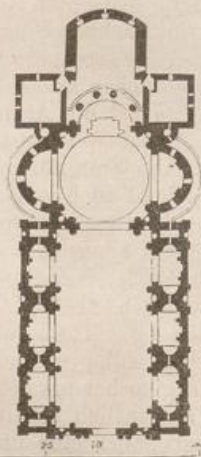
Kirche del Redentore zu Venedig, Grundriss.
